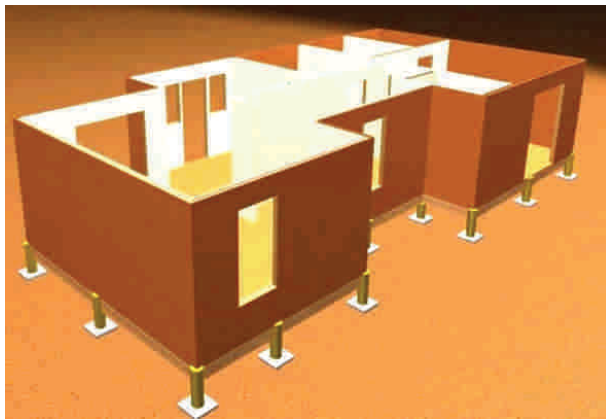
4: Primer piso de una vivienda con sus muros perimetrales alzados (tabiques soportantes).
